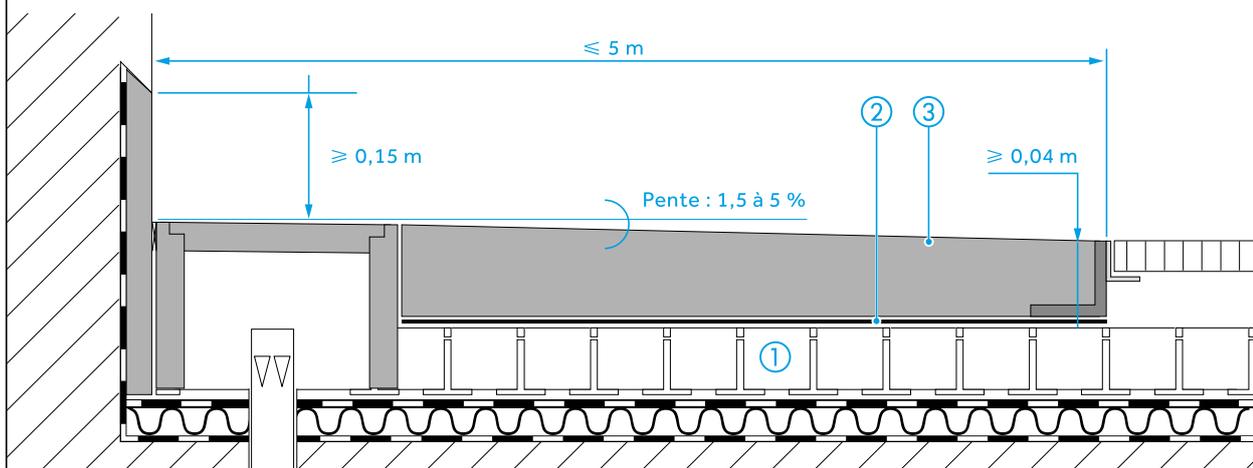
Toiture accessible aux piétons avec dallage en béton sans rétention temporaire
